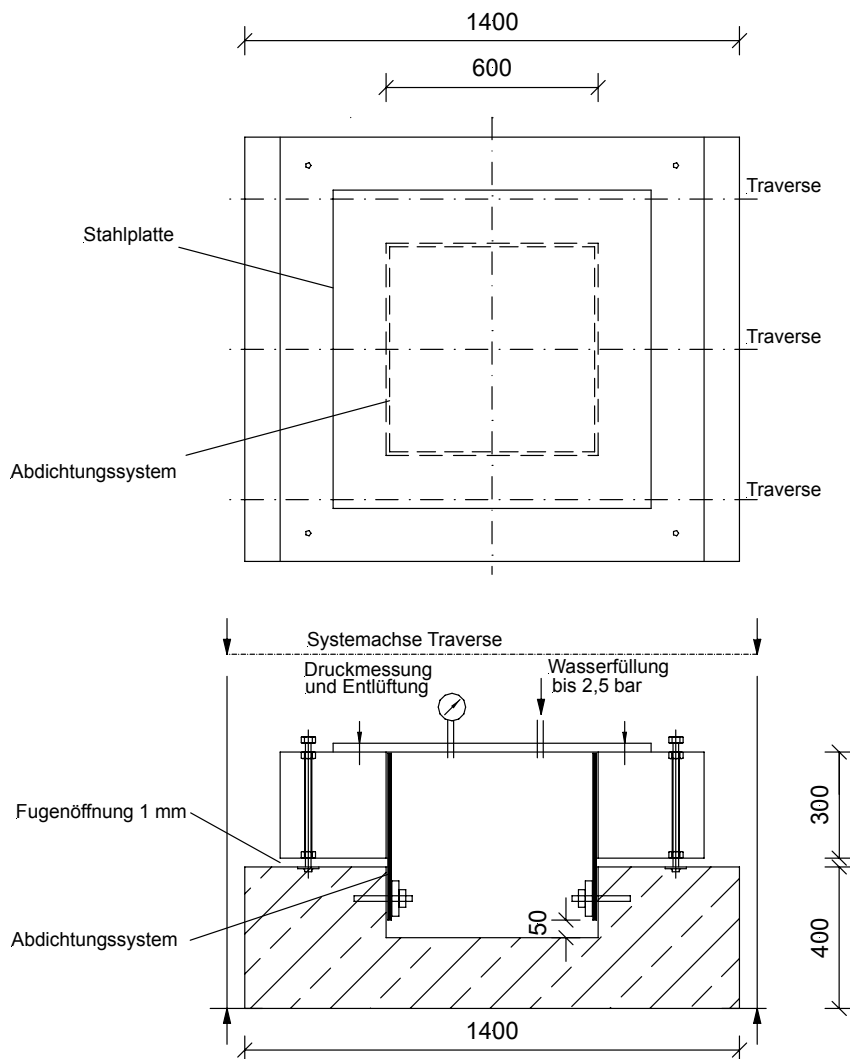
Versuchsaufbau Funktionsprüfung Klemm- und Los-Festflanschkonstruktion, Prinzipskizze
